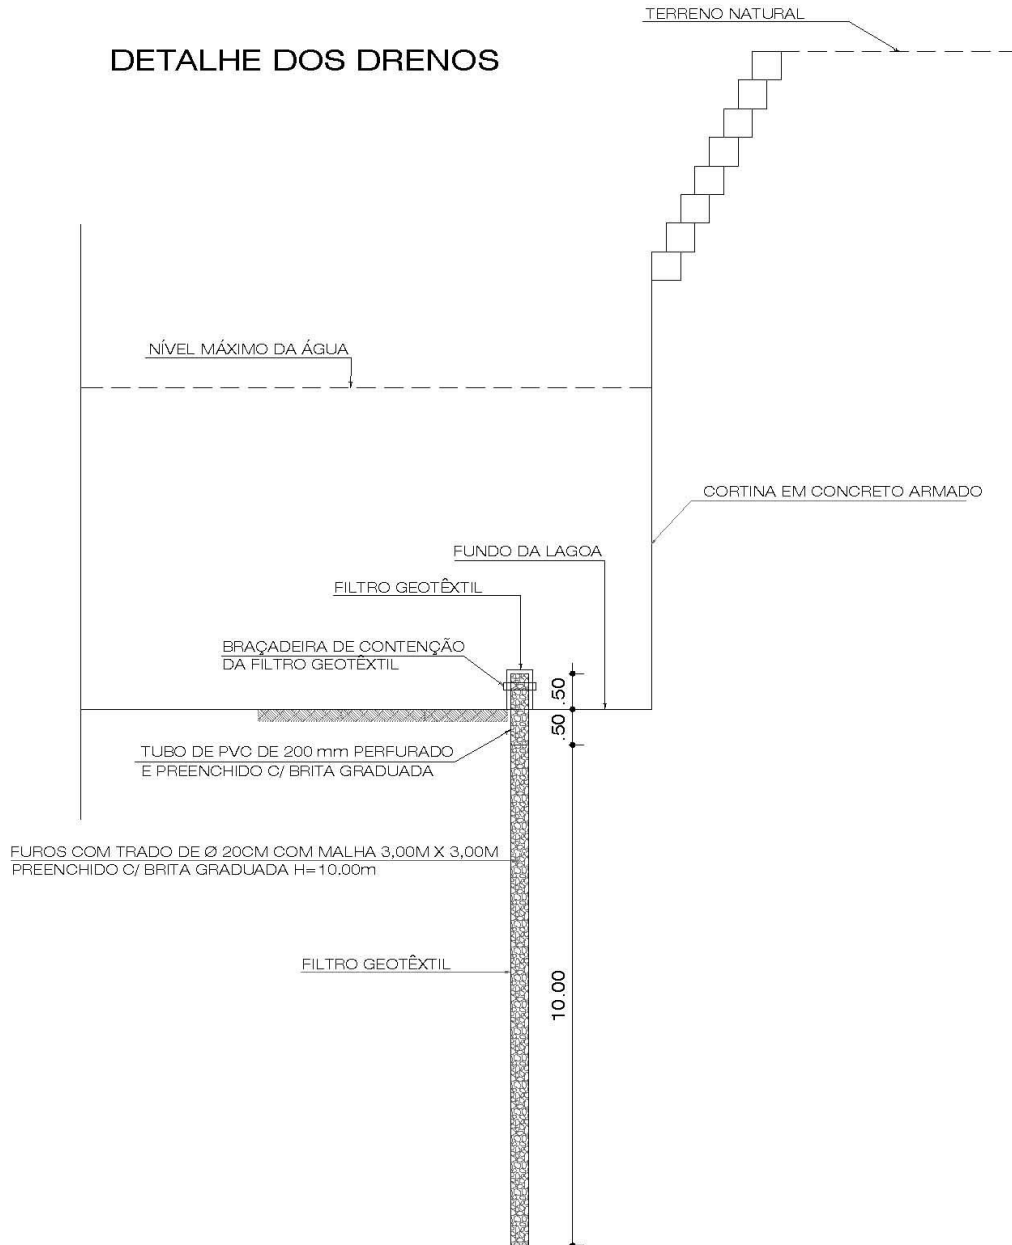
Detalhe de reservatório de detenção e infiltração com dreno
